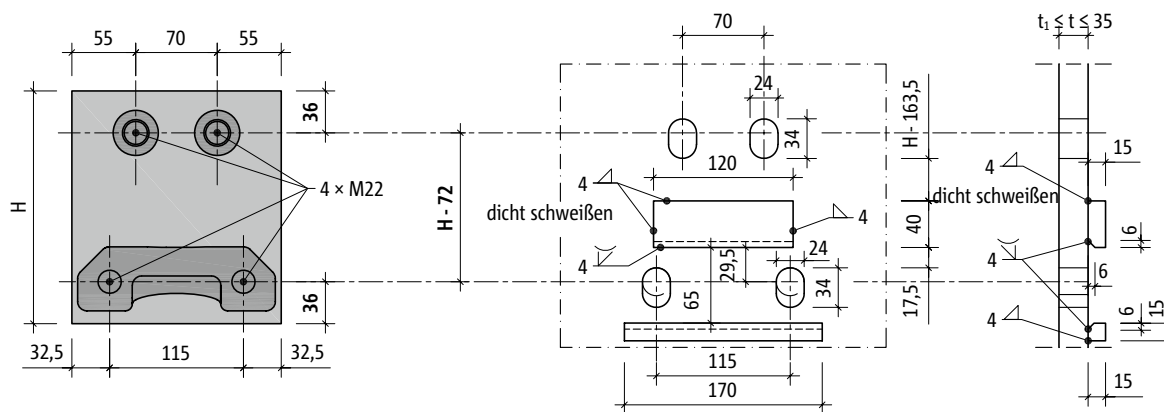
Schöck Isokorb® T Typ SKP-MM2 mit CV26: Konstruktion des Stirnplattenanschlusses mit Betondeckung CV26; Rundlöcher unten, alternativ Langlöcher und eine zweite Knappe zur Übertragung der negativen Querkraft (ersetzt durch T Typ SKP-MM2-...-CV28)
